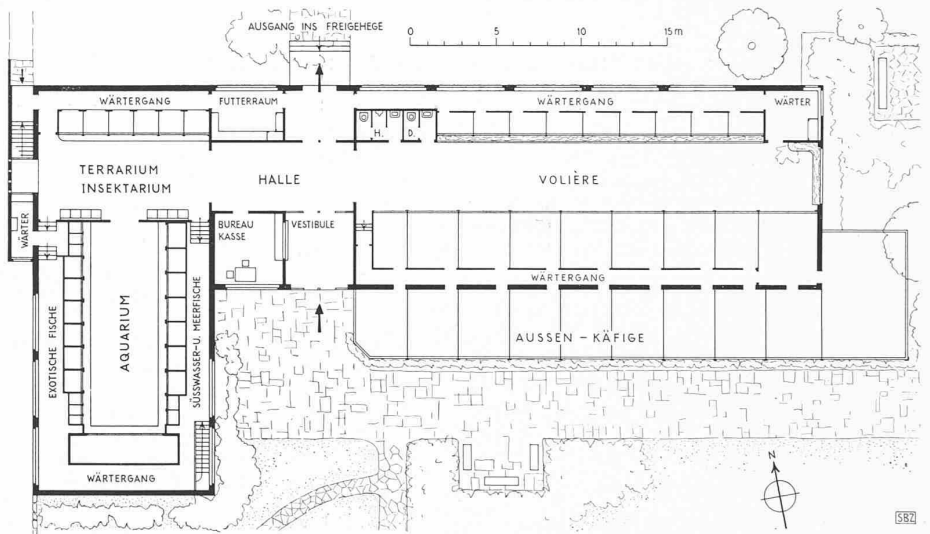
Grundriss 1 : 400 des Vivarium-Baues im Dählhölzli. Arch. E. HOSTETTLER, Bern
